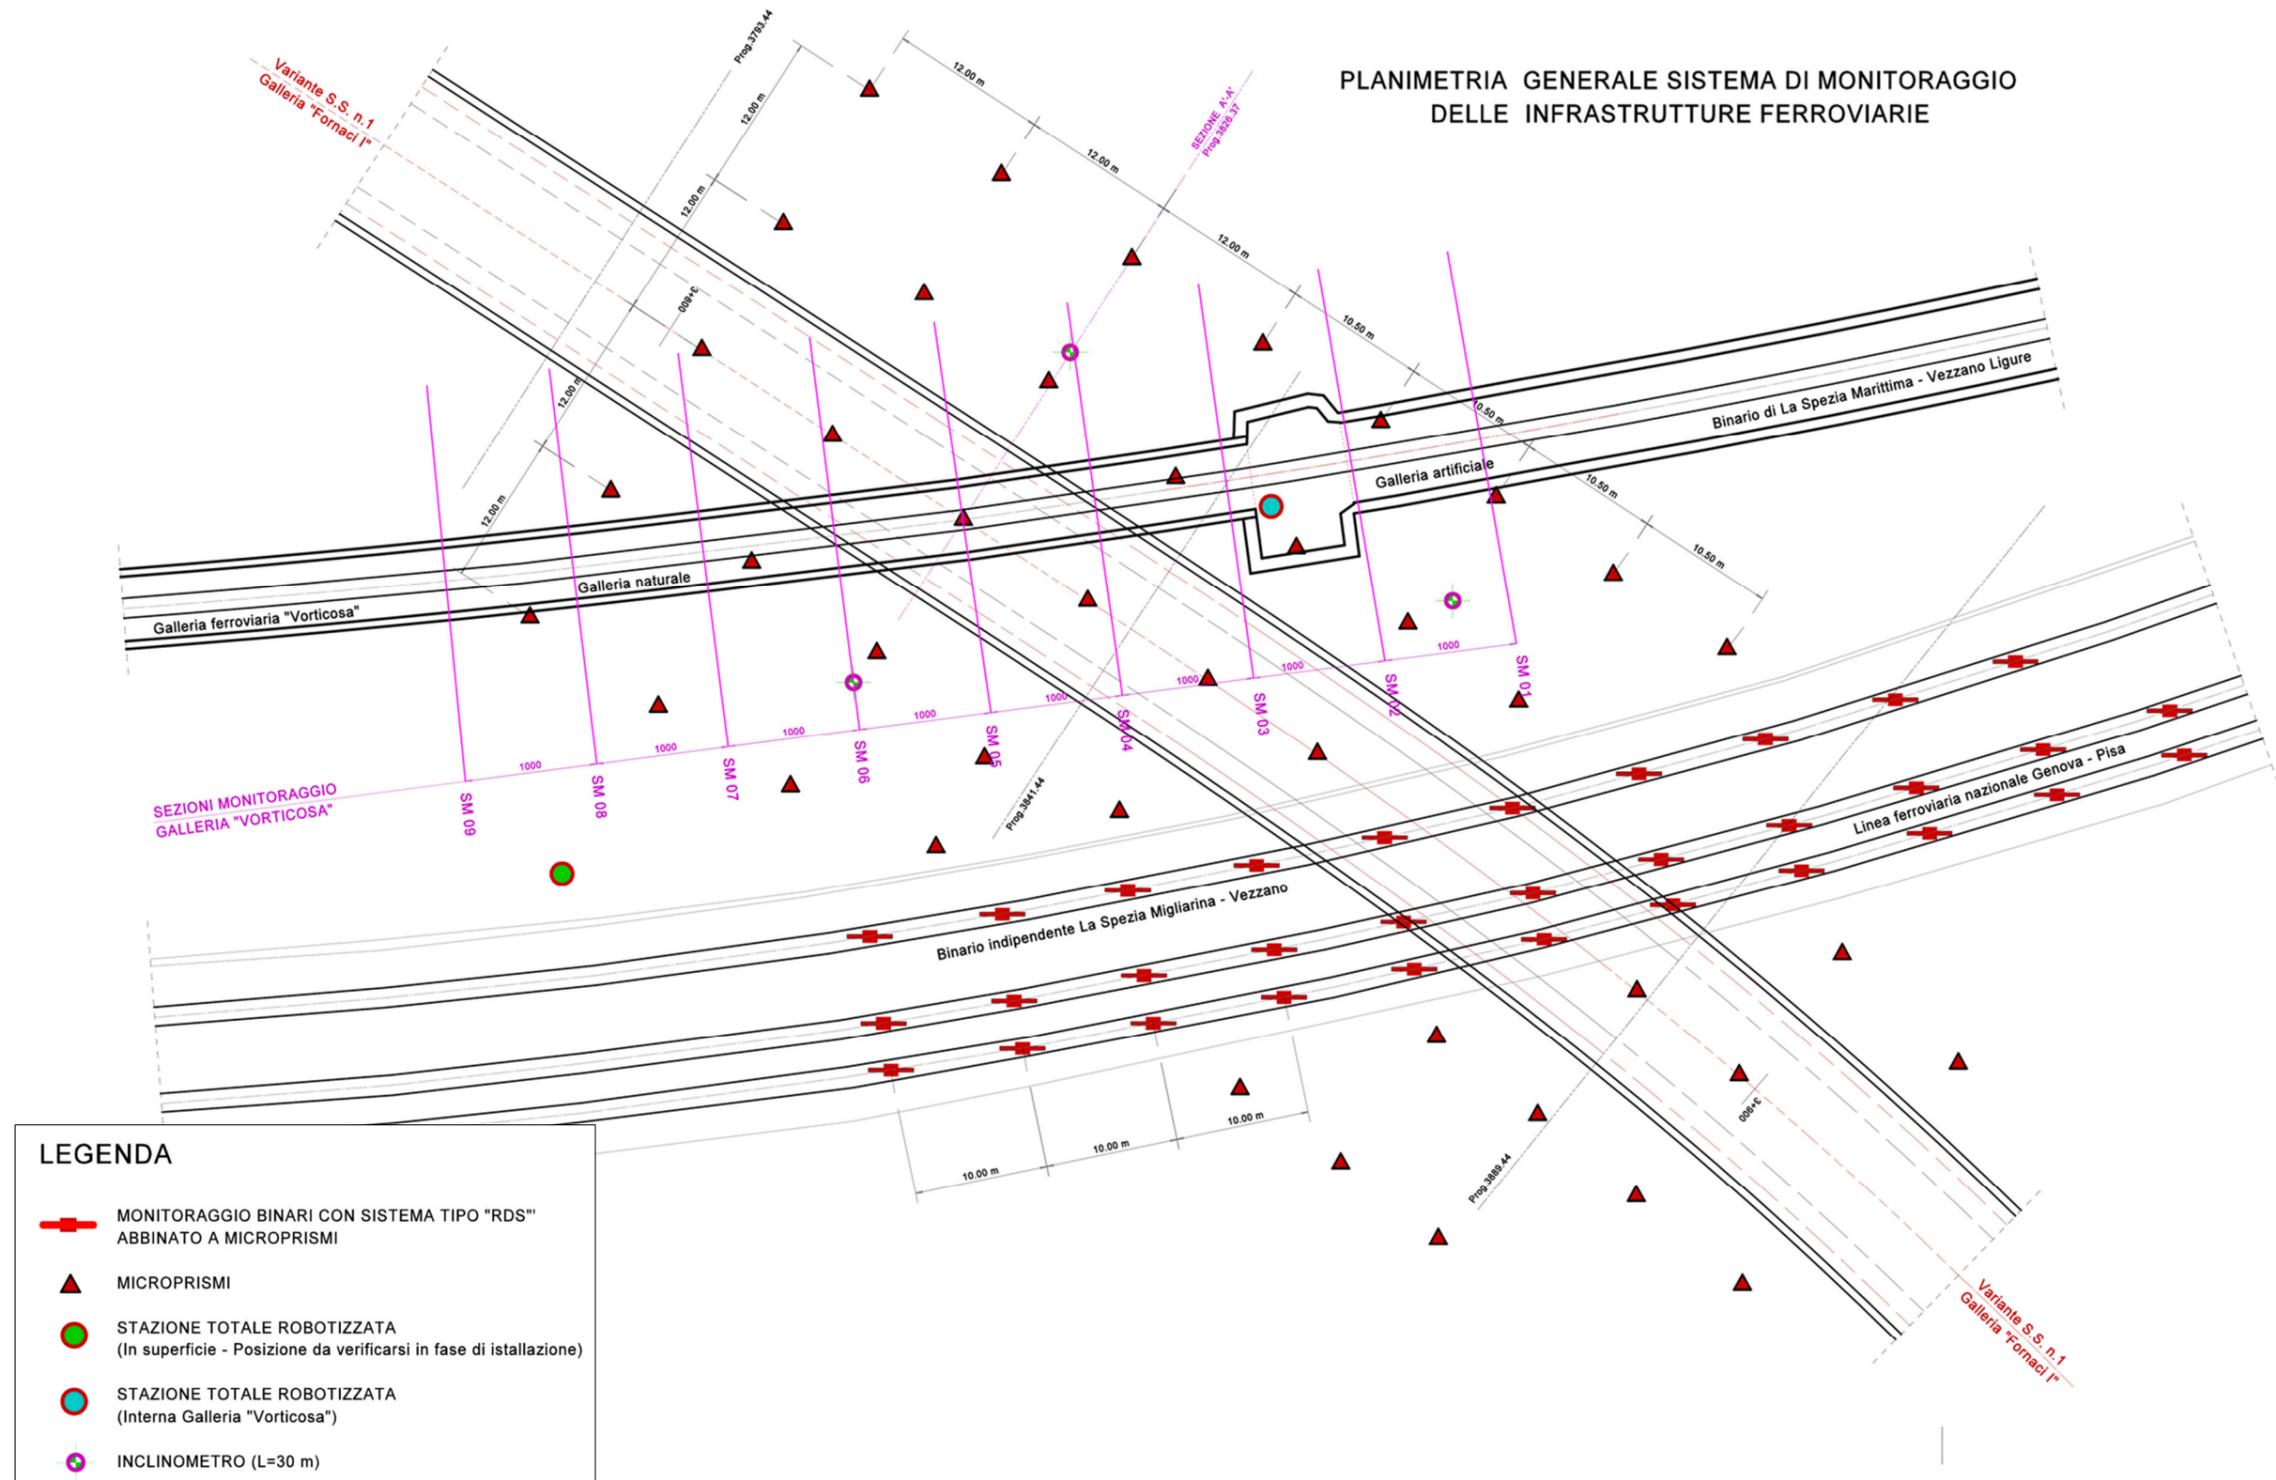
Sistemi di monitoraggio – Stralcio planimetrico
